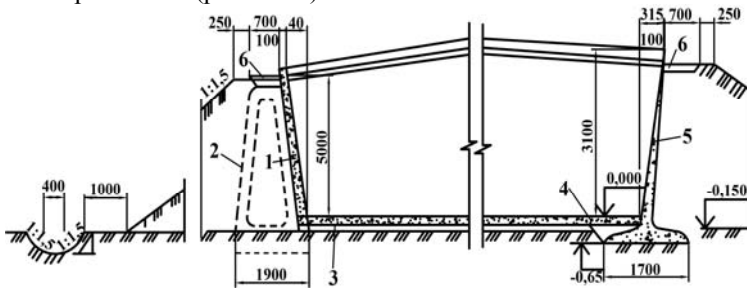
Конструкція наземних силосних траншей із збірних залізобетонних елементів:
